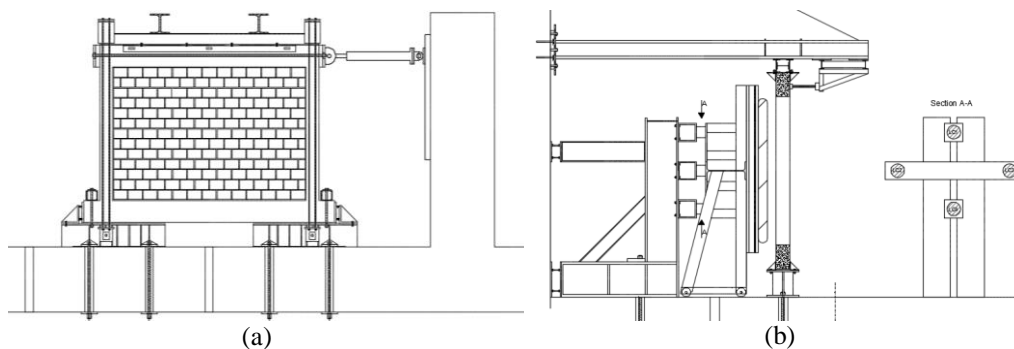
Esquemas de ensaio: (a) ensaio cíclico no plano; (b) ensaio para fora do plano
